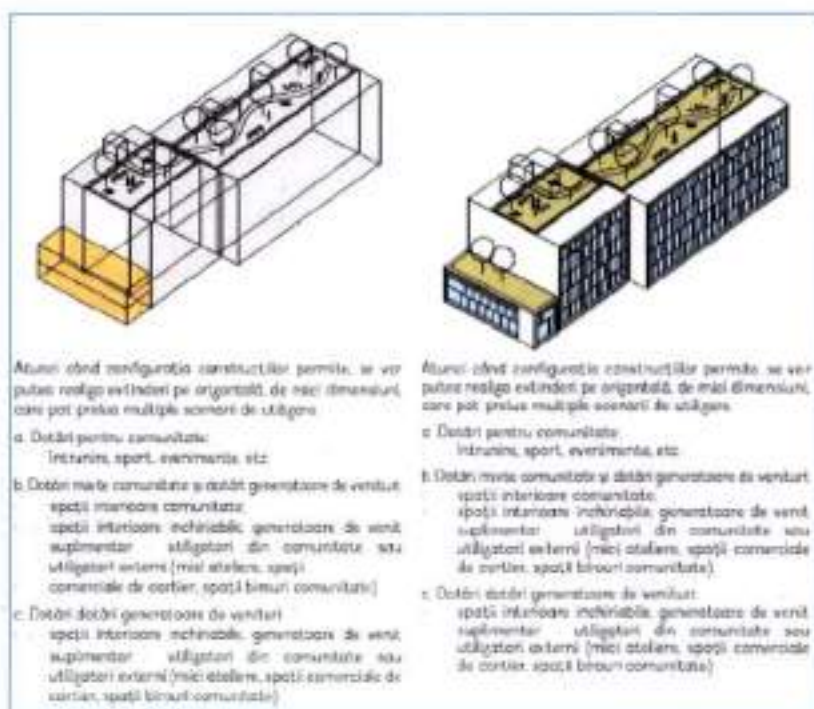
Extindere pe orizontală cu spații pentru utilizare comună cu/fără funcțiuni generatoare de venit _varianta D
